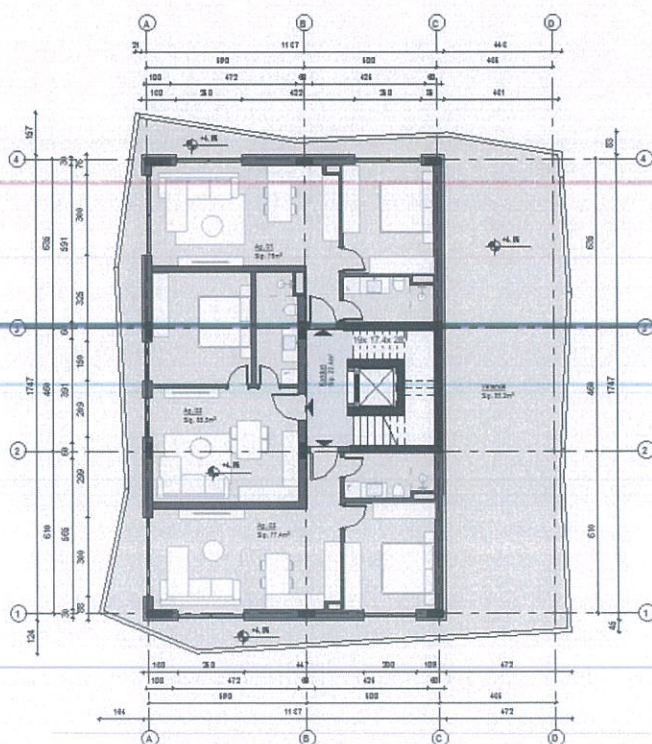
Planimetria e katit +3 me sipërfaqe 242.8 m² (banim)
